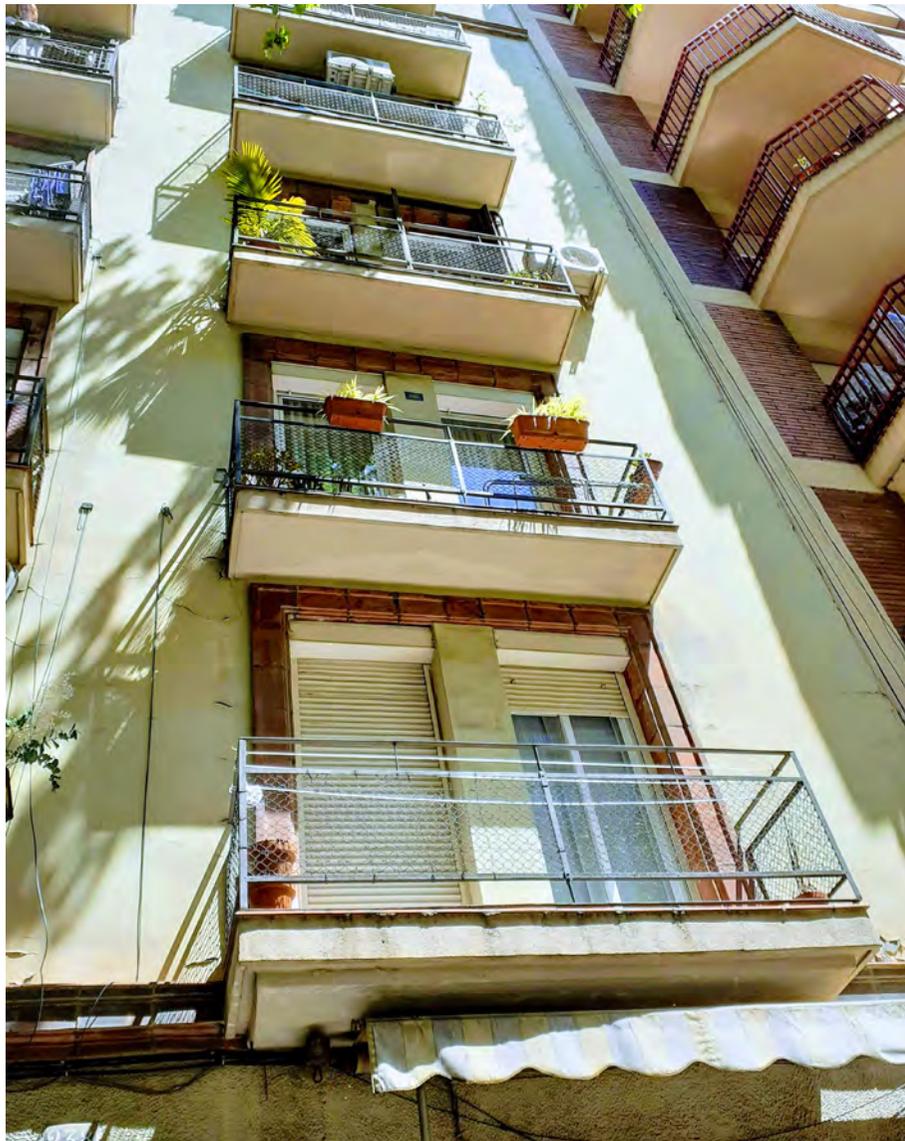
Detalle de la fachada de la casa Vedruna, calle Navas de Tolosa, Barcelona
